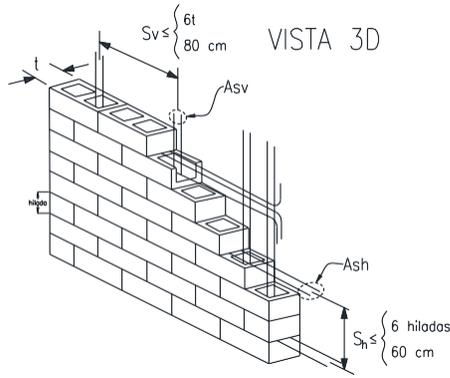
Requisitos para mampostería con refuerzo interior
